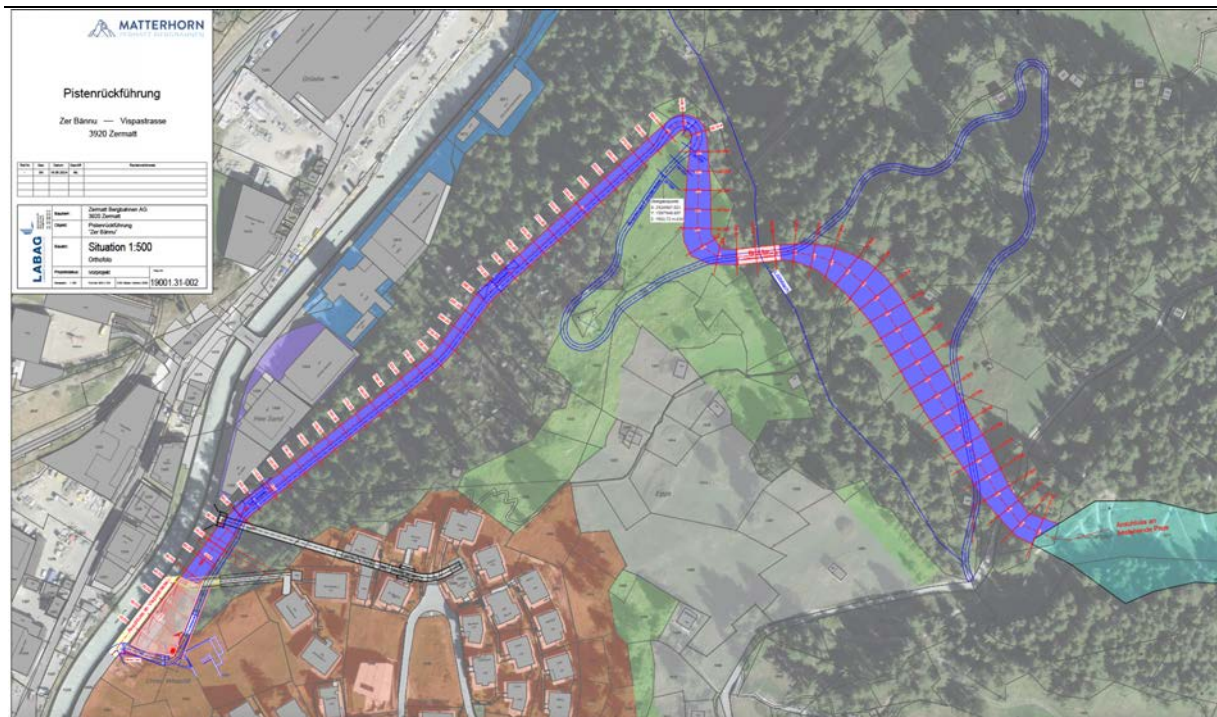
Planausschnitt mit vorgesehener Linienführung Pistenverlauf (Rot) und geplante neue Forststrasse (blau) (Quelle: LABAG, 2024)
